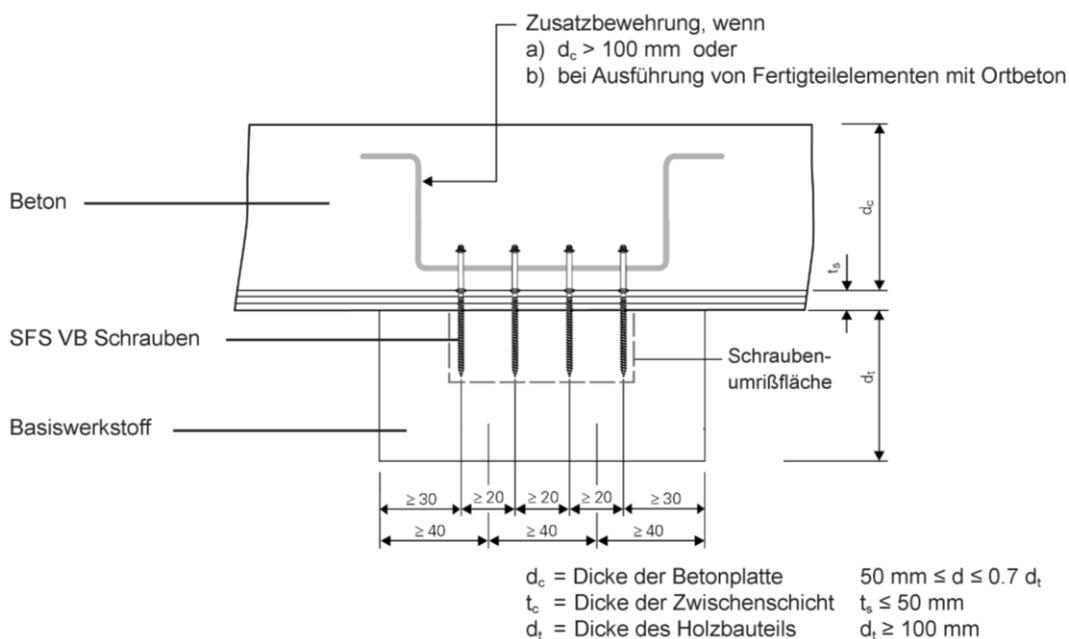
Querschnitt einer Holz-Beton-Verbundkonstruktion mit SFS VB Schrauben
